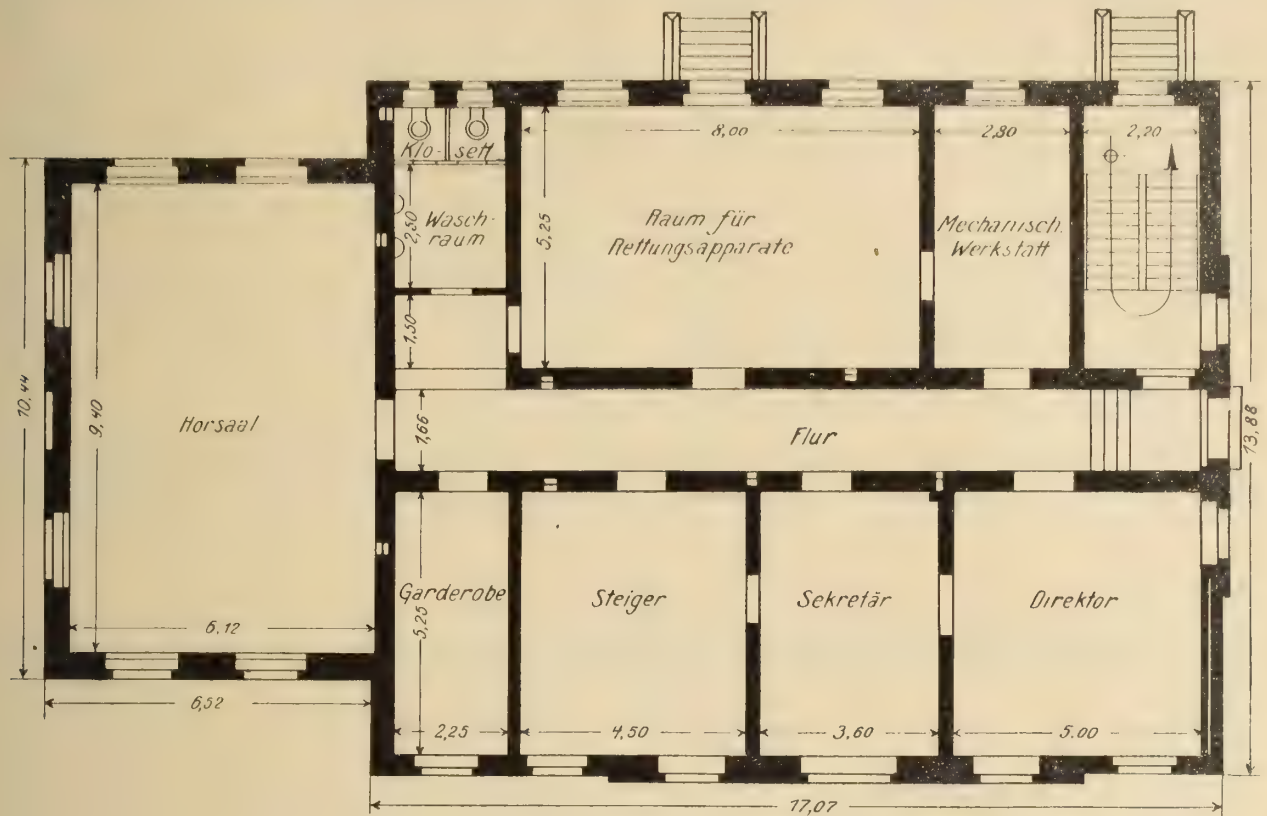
Erdgeschoßgrundriß des Dienstgebäudes.
